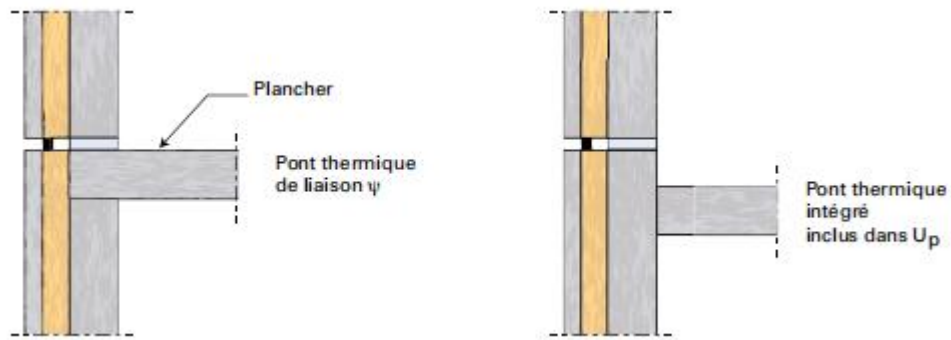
Affectation du pont thermique situé au niveau du joint d'étanchéité en fonction du positionnement du plancher
